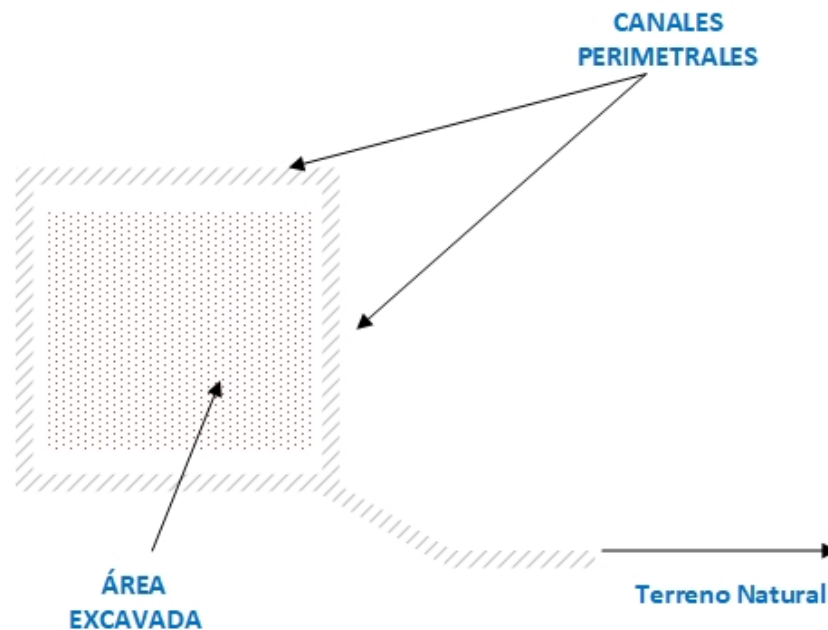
Esquema del Sistema de Drenaje Pluvial – Vista de Planta
